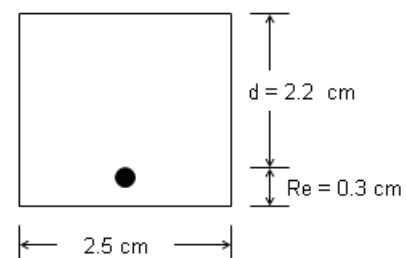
"Dimensiones de sección transversal de la losa". Fuente: Elaboración propia.
